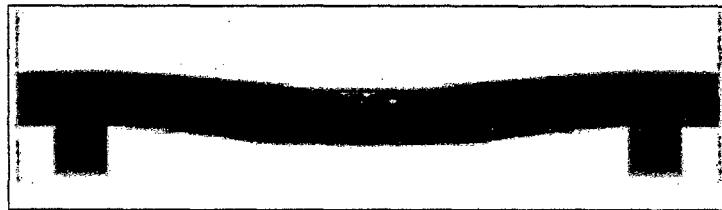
4. Ejemplo de fallo a flexión (compresión) en vigas de concreto. Fuente: (Stuardo P., 2008)
